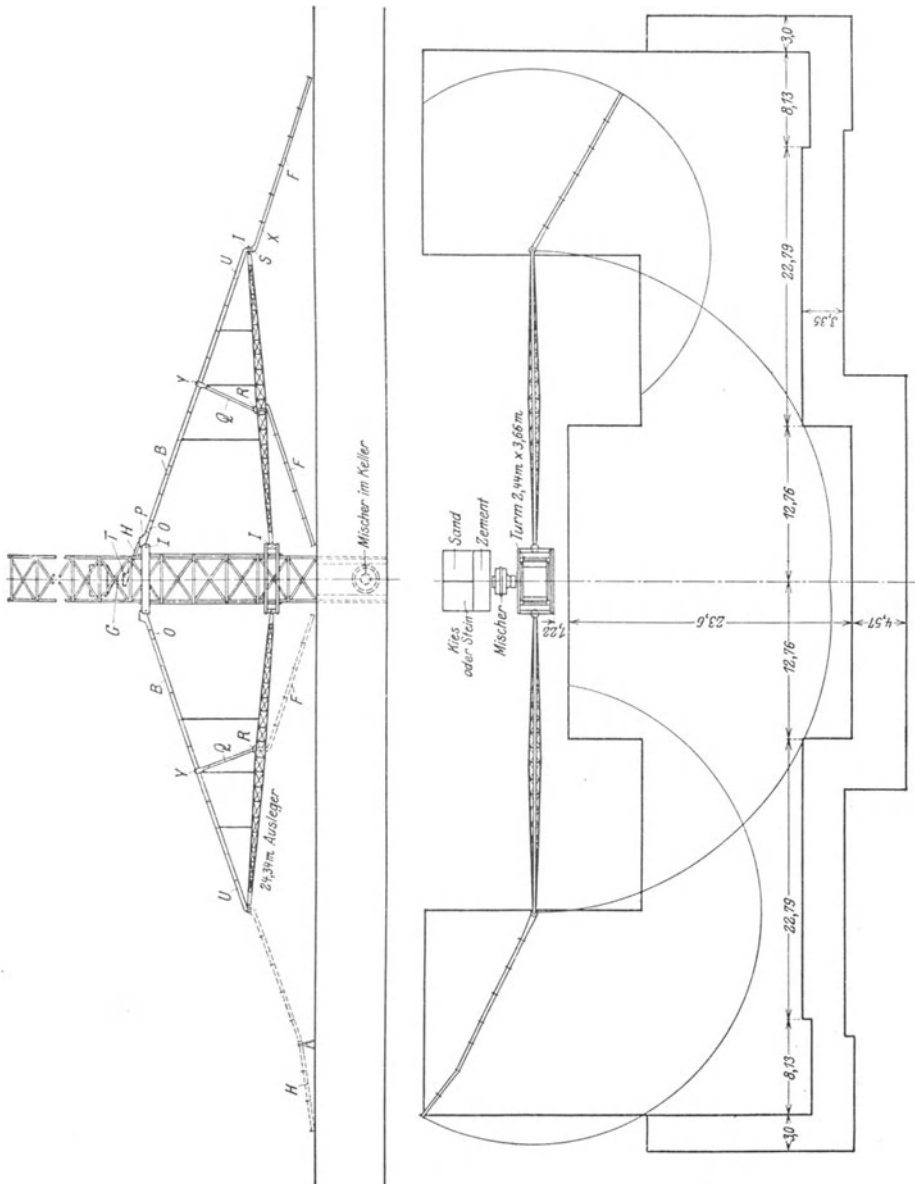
c. Darstellung einer Anlage zum Gießen von Beton.
